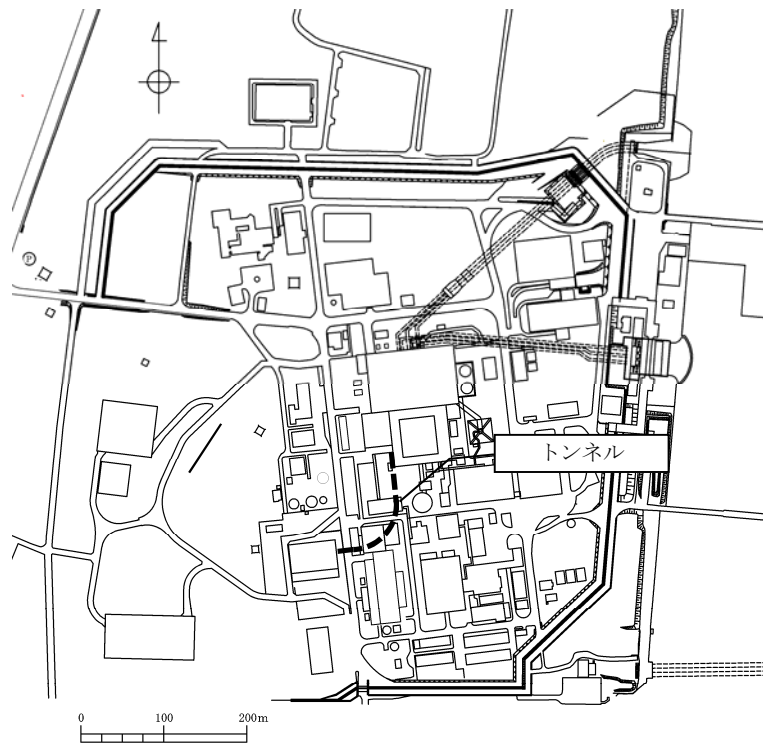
(1) トンネル 平面配置図（全体平面図）
